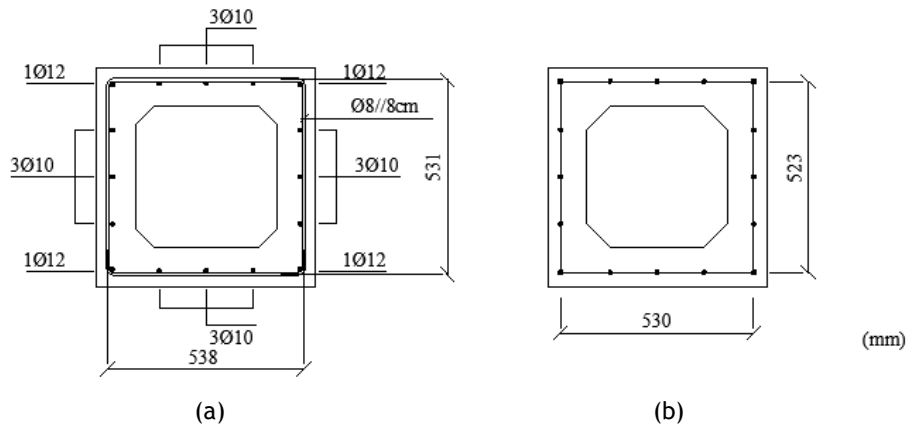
(a) Secção transversal real da viga A2, (b) Secção transversal simplificada da viga A2
